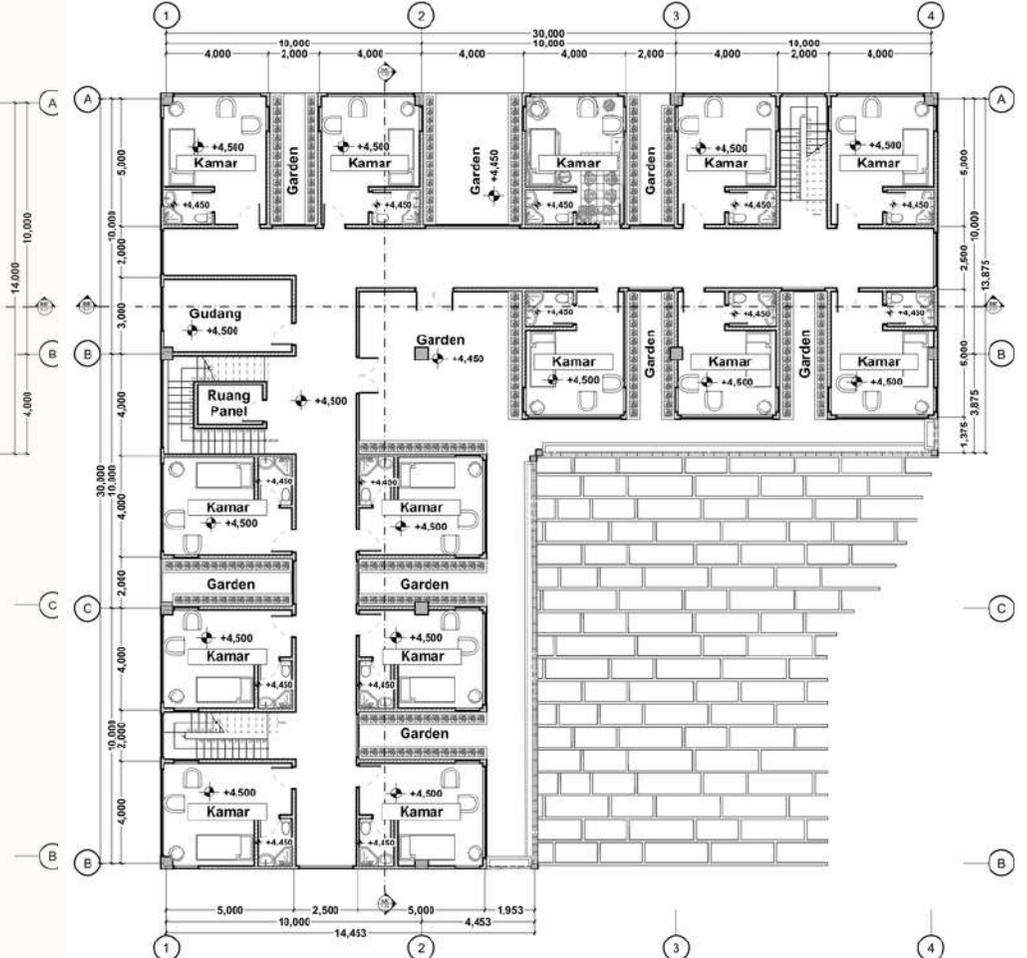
Denah Gedung Utama Lantai 2
